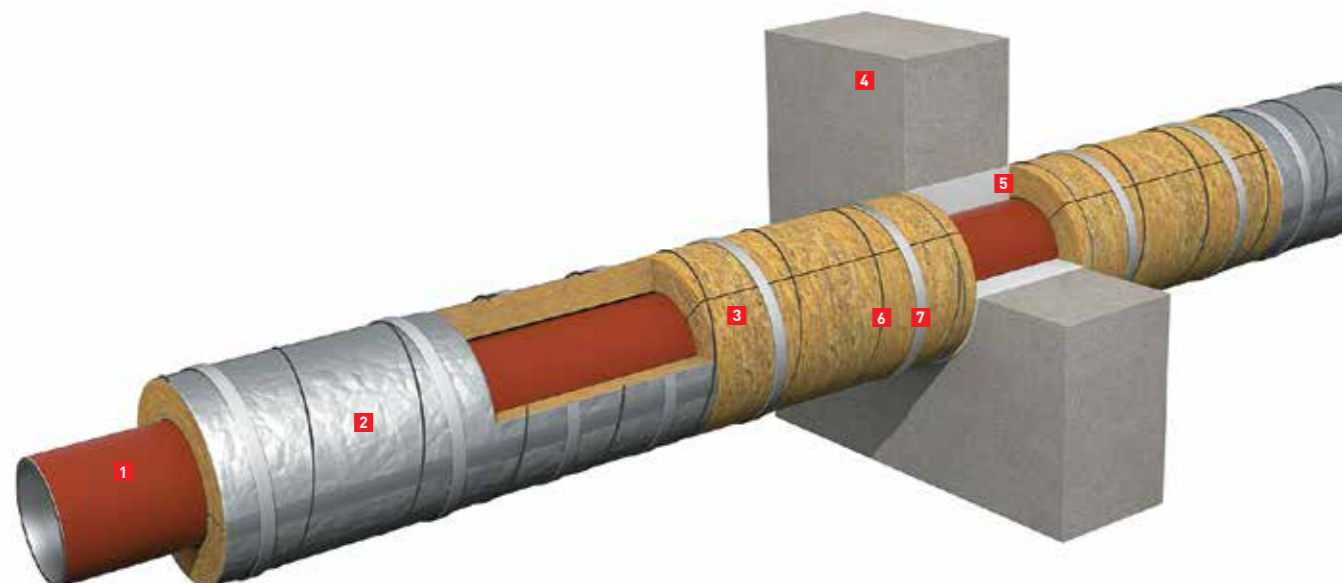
Монтажное сопряжение воздухопроводов со строительными конструкциями
